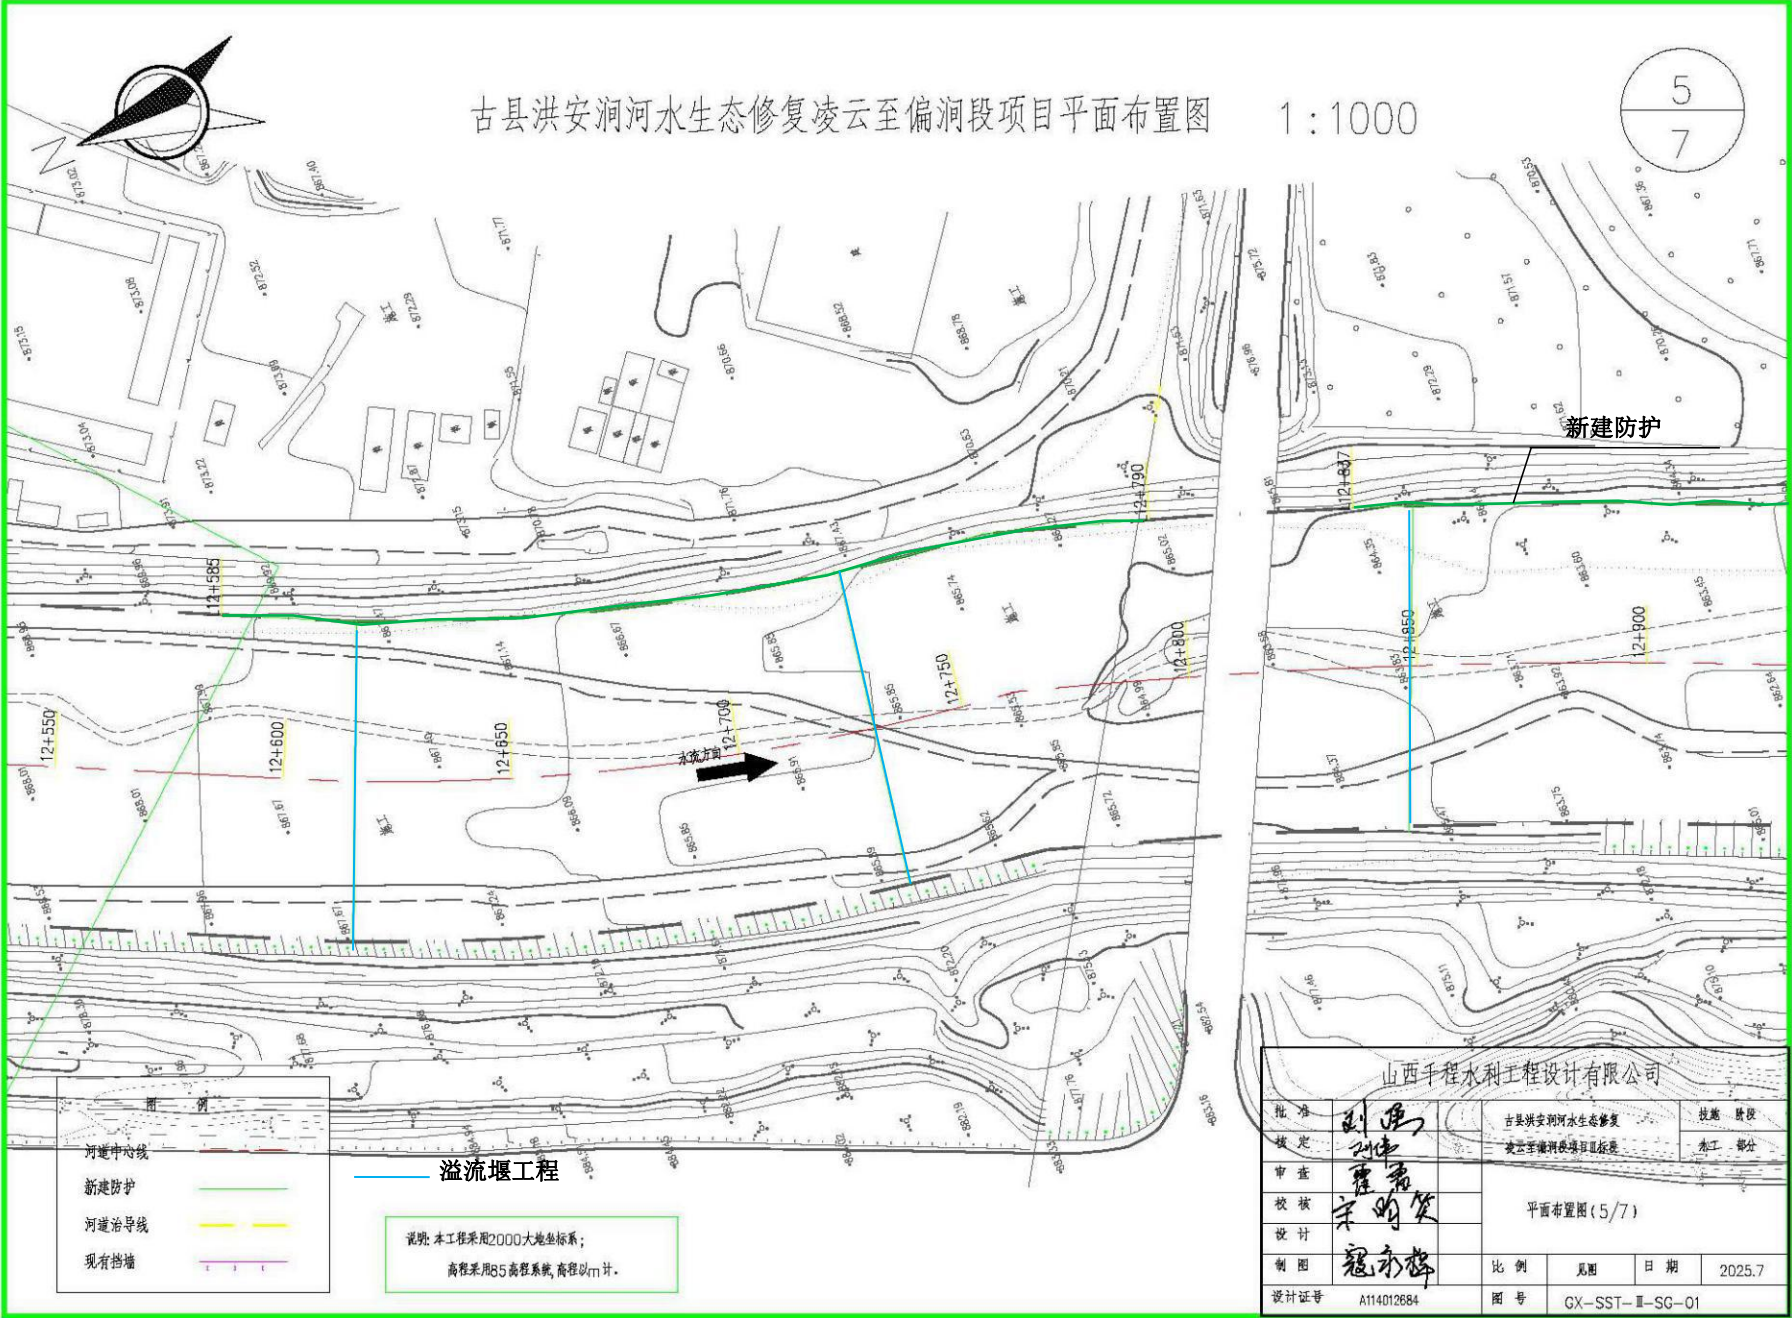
(9) 工程总平面布置图 (桩号 12+150-12+900)
